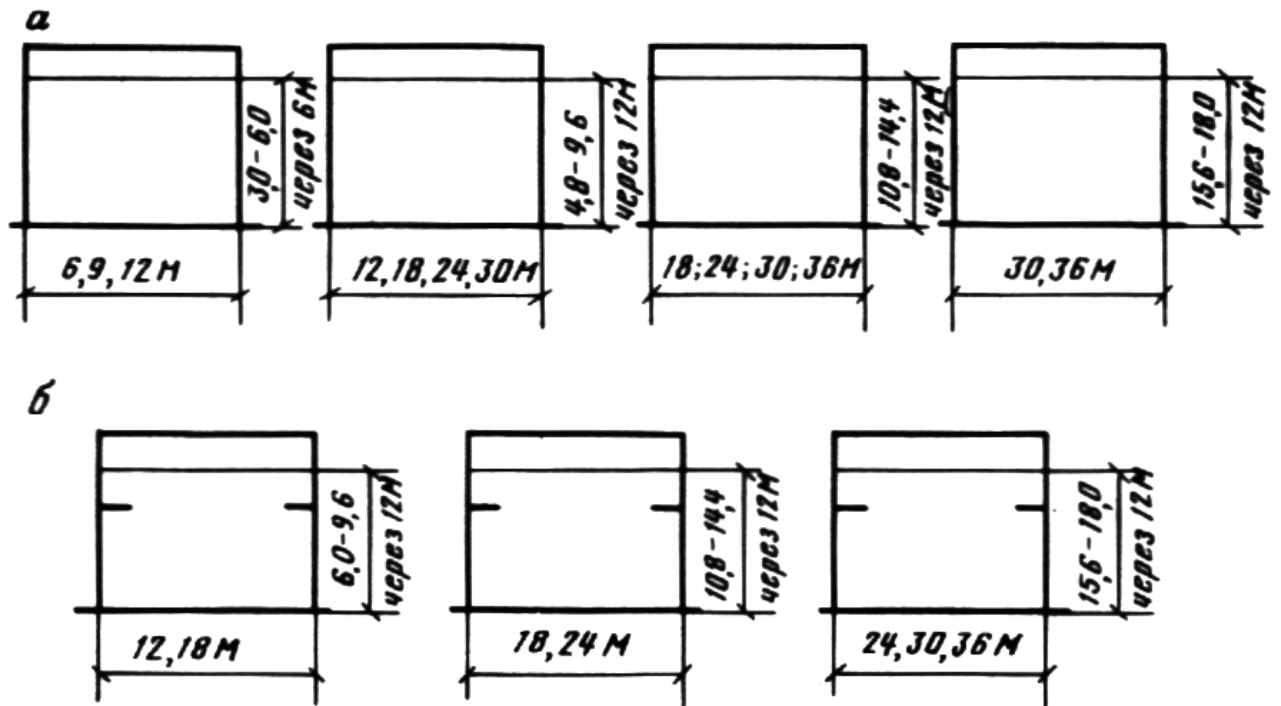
Унифицированные габаритные схемы одноэтажных зданий:
